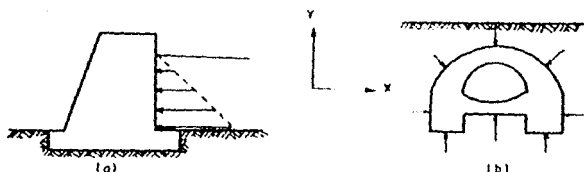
a) Muro de retención. b) Túnel o alcantarilla
